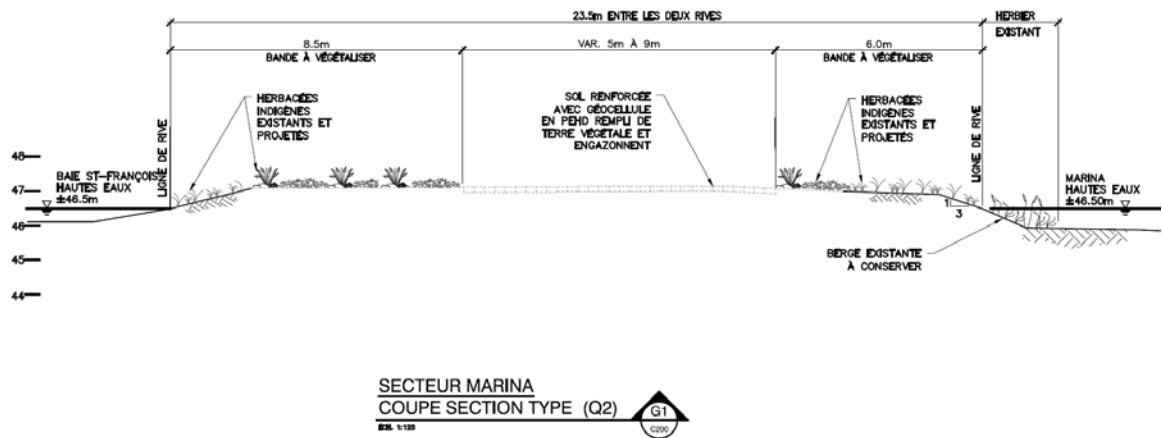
Coupe-type G1 – Langue de terre section ouest sans muret de protection
